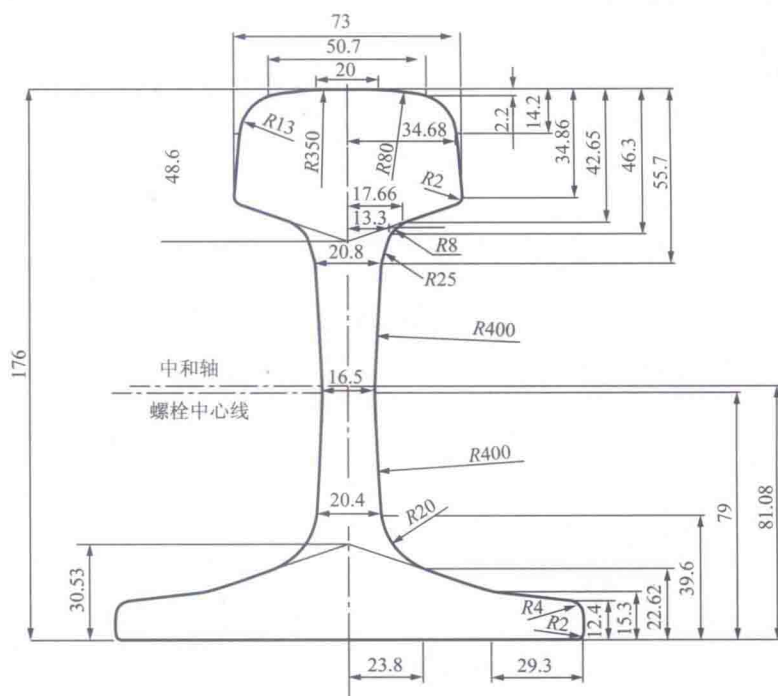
60kg/m 钢轨截面尺寸图(尺寸单位:mm)
